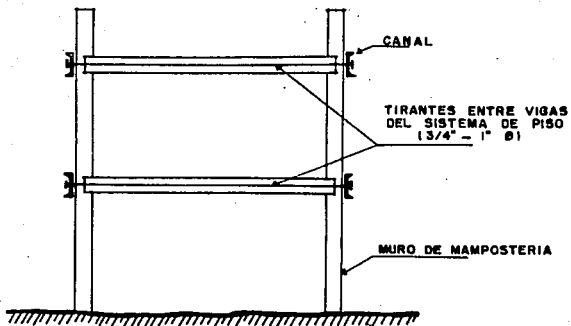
Anclaje de muro a muro (Ref. 15)
